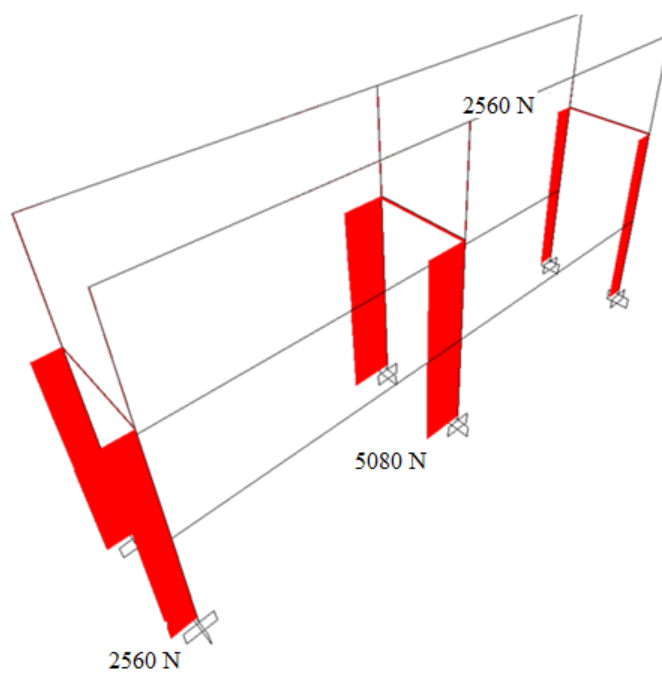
Diagrama de cargas axiales sobre la estructura. Fuente. SAP2000.
